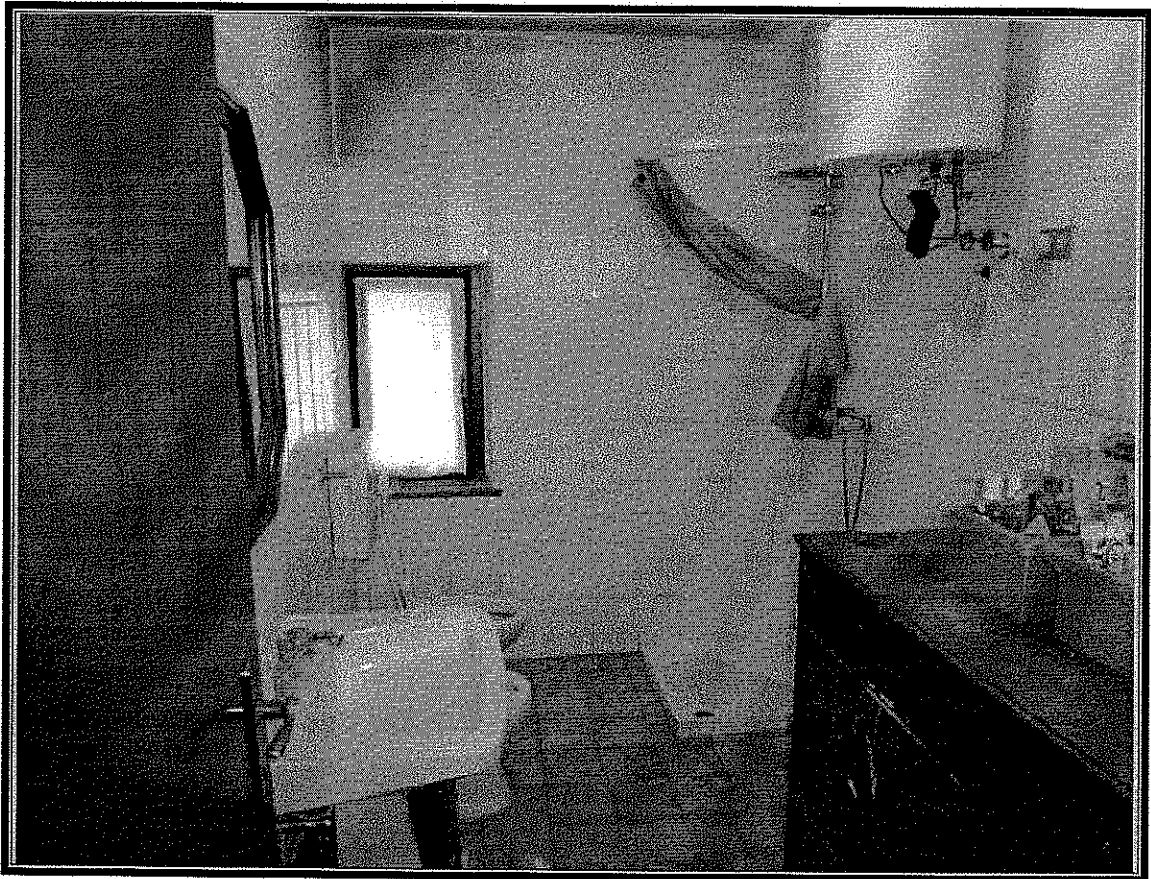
locale camera n.2 - 1<sup>^</sup> piano
